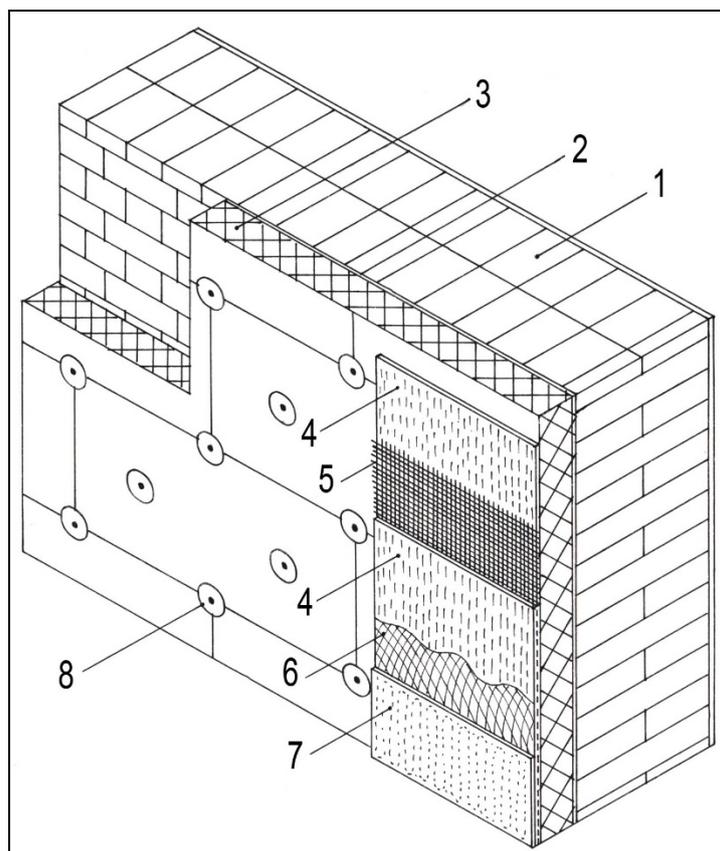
Принципиальное конструктивное решение легкой штукатурной системы утепления. 1 – капитальная часть стены; 2 – клеевой слой; 3 – эффективный утеплитель; 4 – армированный слой; 5 – армирующая сетка; 6 – грунтовка; 7 – защитно-декоративный слой; 8 – дюбель-анкер
